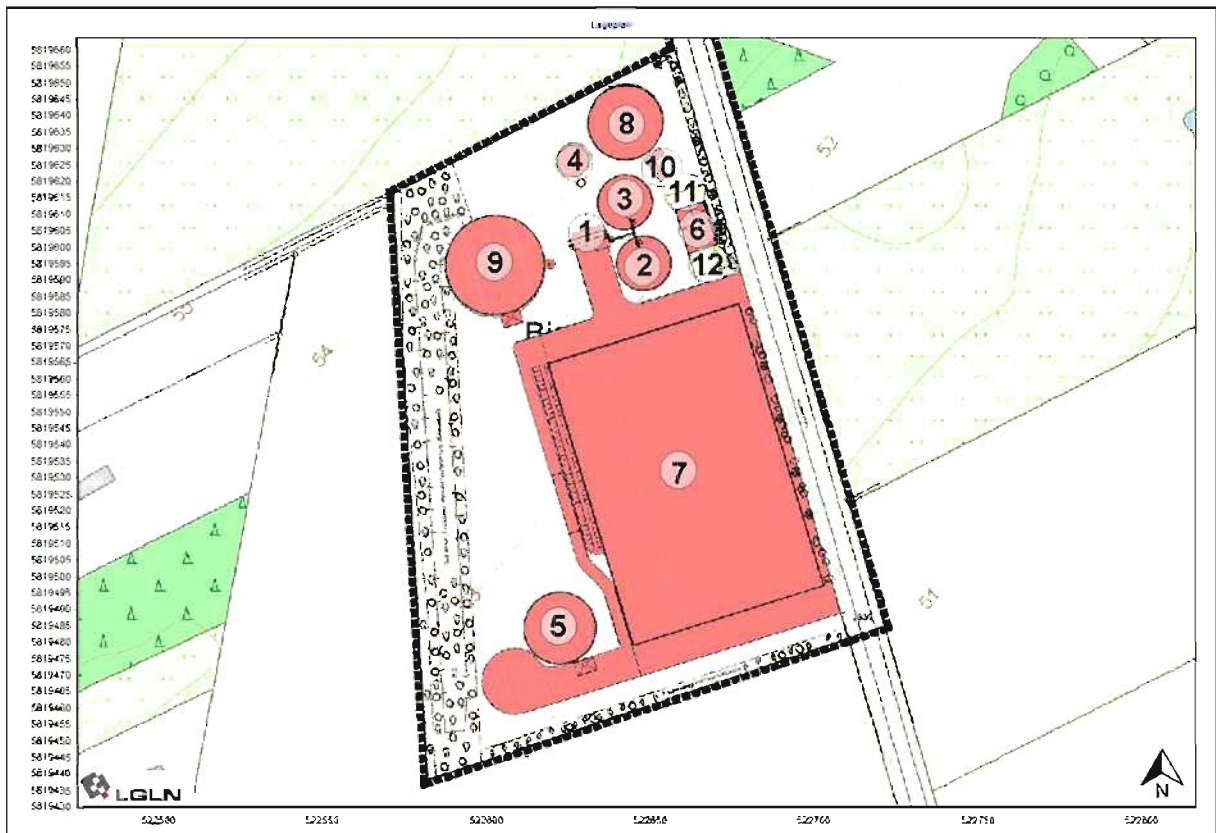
Lageplan der Biomasseanlage „Resserithe“ der Biogas Schneeren GbR.
